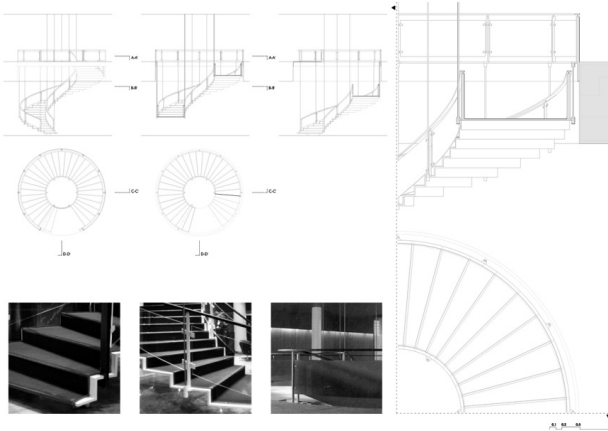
Planta, alzado y sección vertical de la escalera del Hotel SAS. Fotografías de detalles. 2011. Foto-autor.
